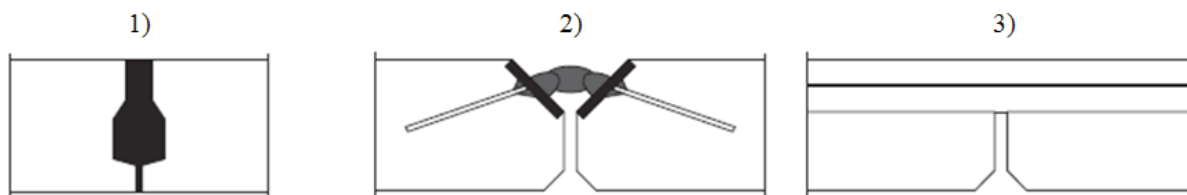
Типы соединений между элементами настилов по EN 1992-1-1: 1) бетонные или растворные; 2) сварные или болтовые; 3) железобетонные
